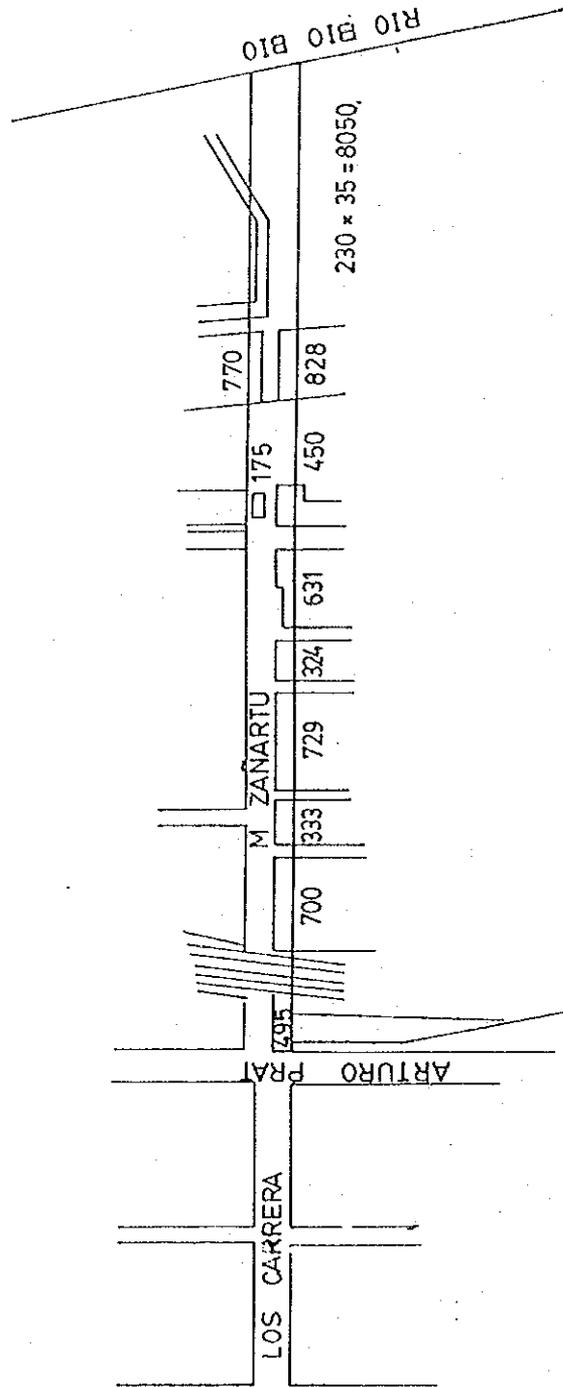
Plano 3 y Plano 4, del lado de Concepción
